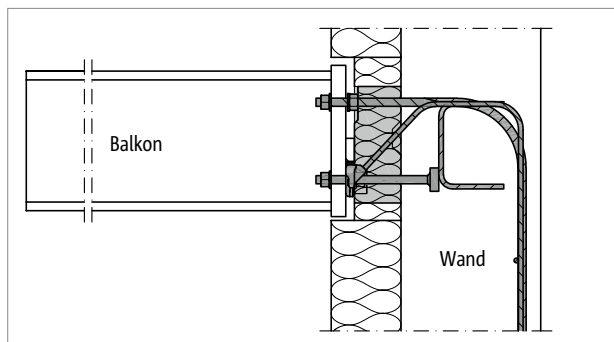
Schöck Isokorb® T type SK: aansluiting aan de vloer van gewapend beton
